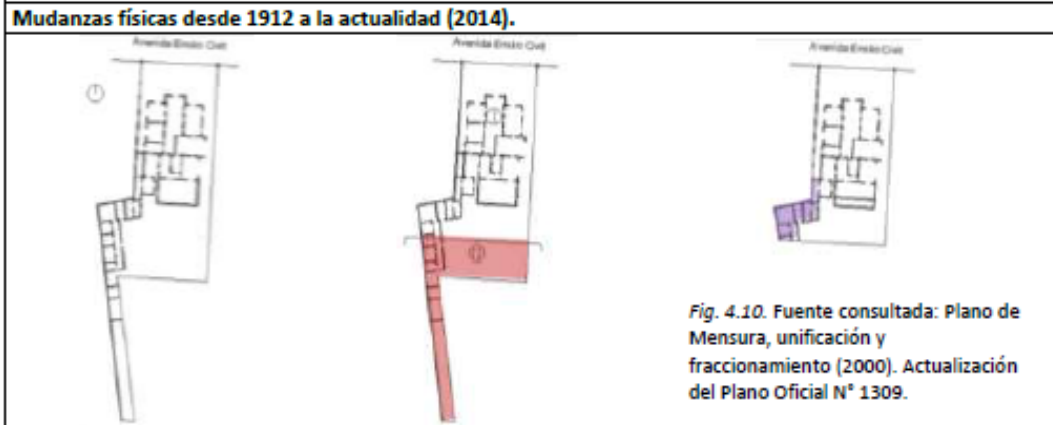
Fuente consultada: Plano de Mensura, unificación y fraccionamiento (2000). Actualización del Plano Oficial N° 1309.
